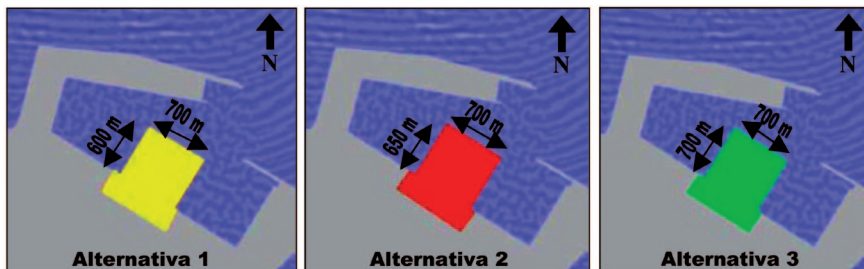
Disposición en planta de las Alternativas 1, 2 y 3 (forma rectangular).
